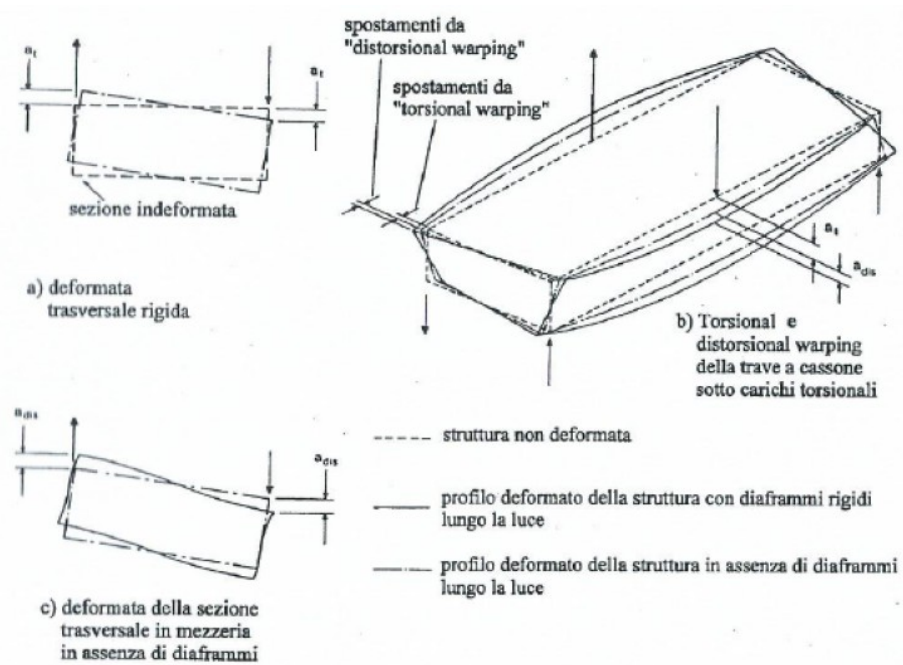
Deformazione trasversale della sezione a cassone indotta dal carico distorcente
